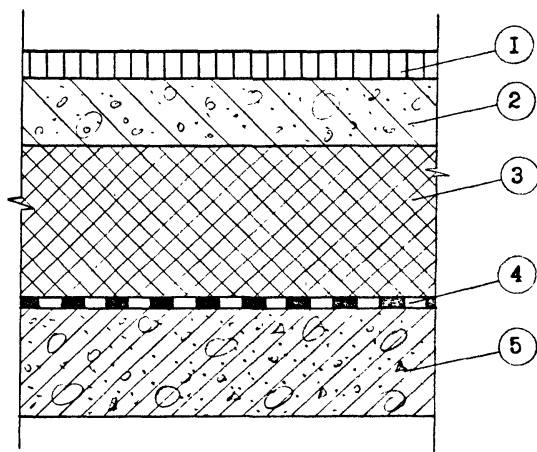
II. Конструктивная схема перекрытия над проветриваемым подпольем. 1 - покрытие пола; 2 - подстилающий слой; 3 - теплоизоляция; 4 - пароизоляция; 5 - железобетонная плита перекрытия.
